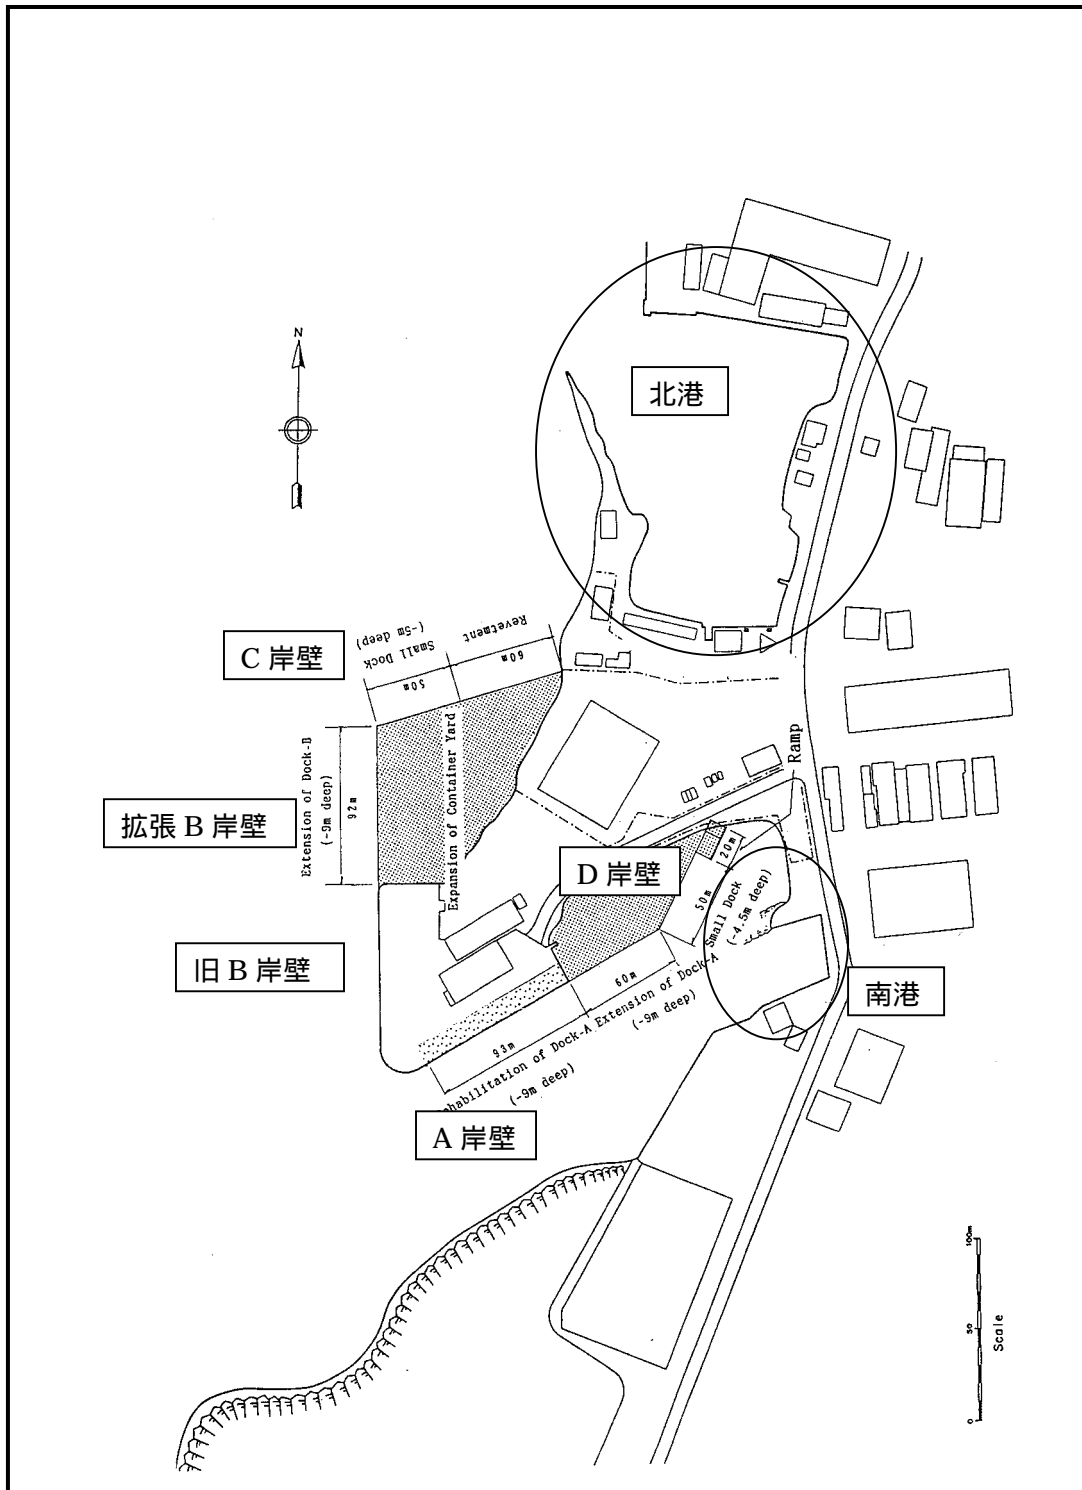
ウエノ港及び小型船舶係留施設（北港）平面図
